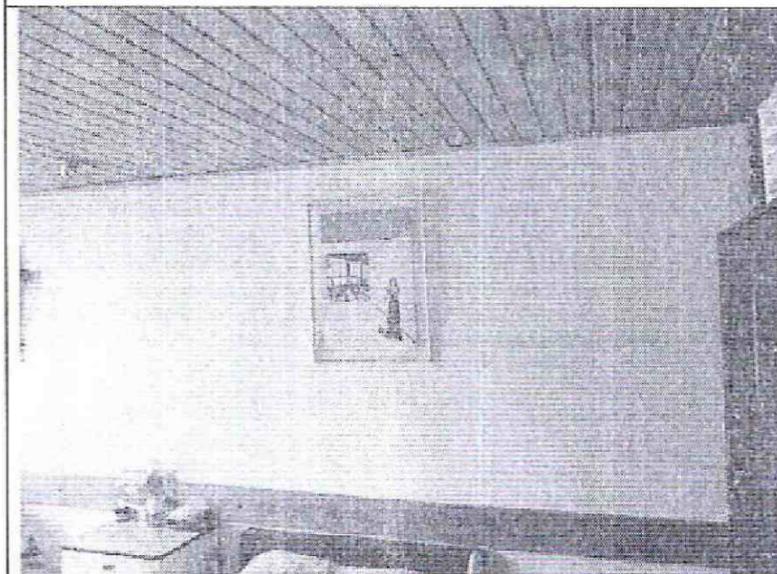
Muros con pequeñas fisuras en primer piso.
